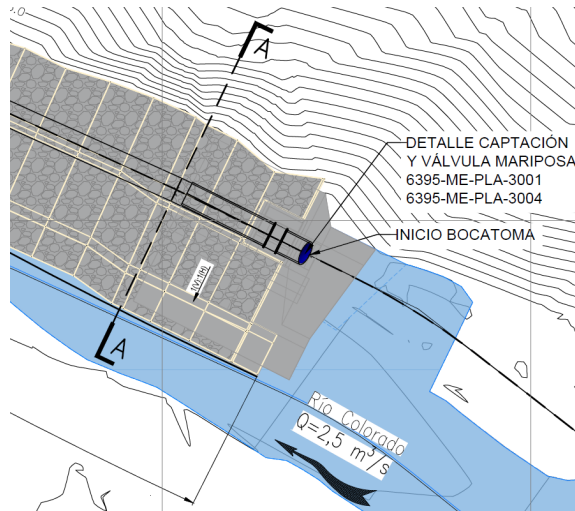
Vista en Planta de la Captación Bocatoma Manzano
